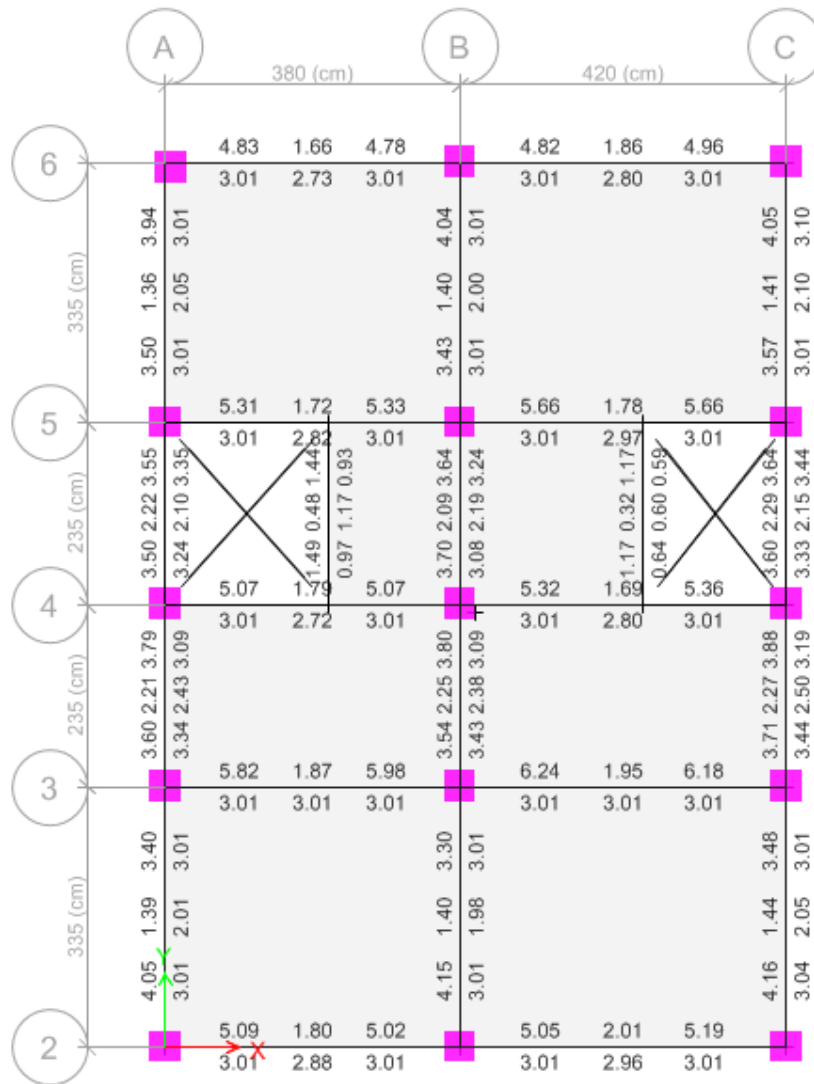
Área de acero en vigas en estructura con VIGACERO. Elaboración propia en programa ETABS 2016 V16.2.
